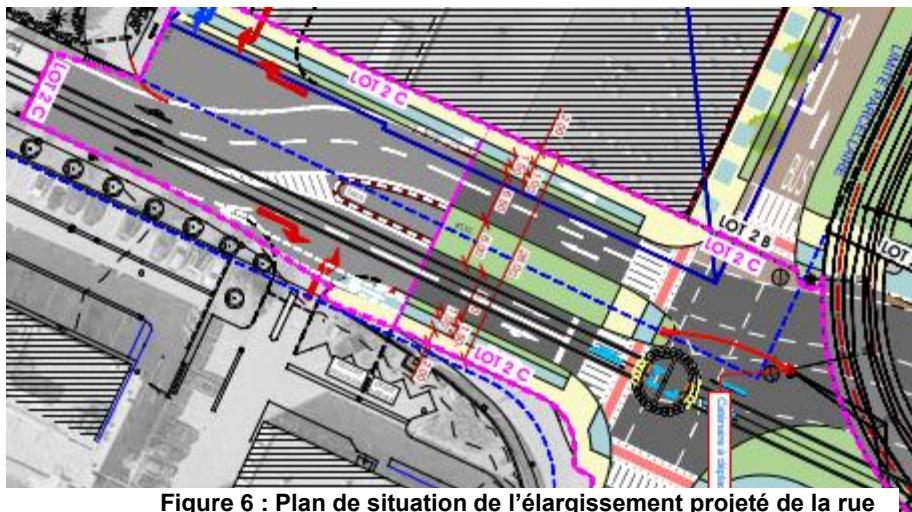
Plan de situation de l'élargissement projeté de la rue des Scillas entre la rue des Bruyères et le boulevard Raiffeisen.
